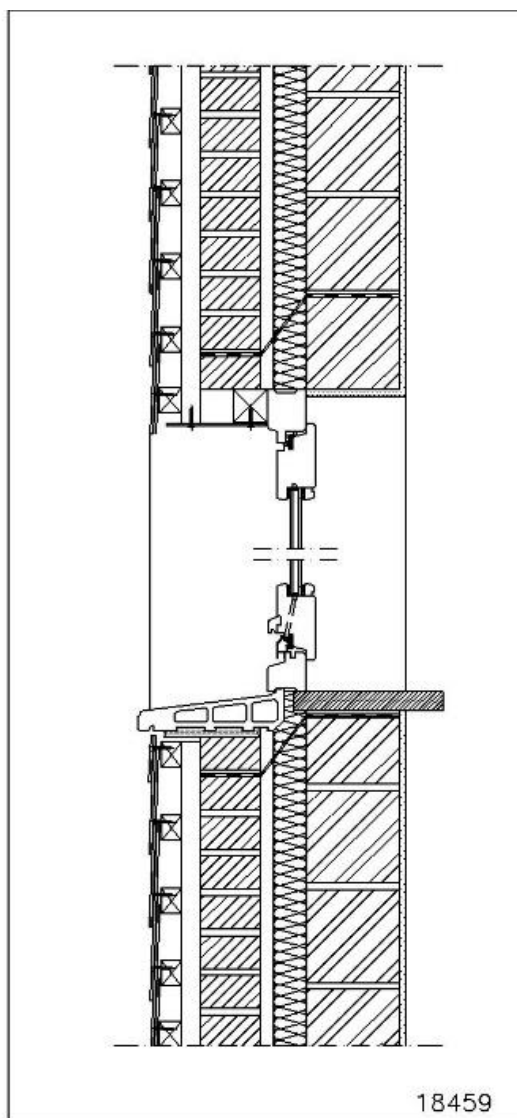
Voorbeeld inspringend rond raam – verticale doorsnede
